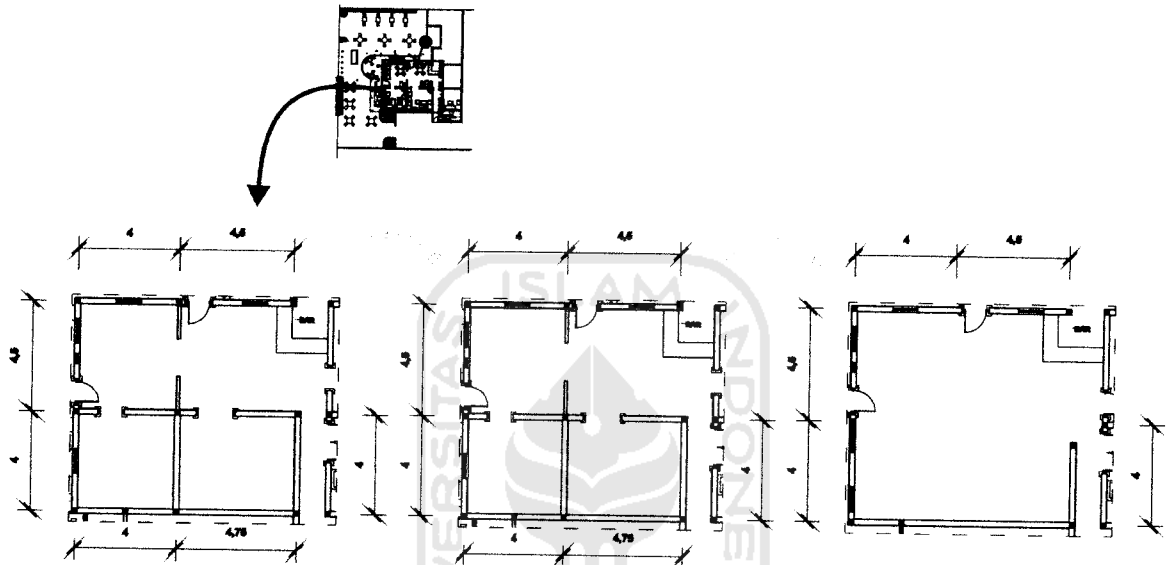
Lantai pada ruangan utama Own Cafe)
